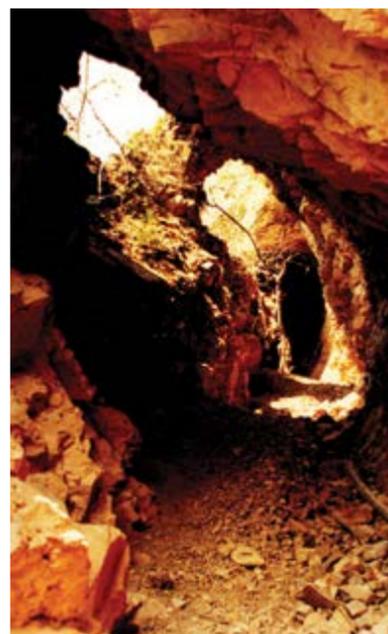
Imágenes del túnel cerca del puente Maucachaca o Huacachaca, Apurímac. Véase en la foto de la derecha las dos ventanas de ventilación que se encuentran al lado izquierdo (foto por Y. Cavero).
